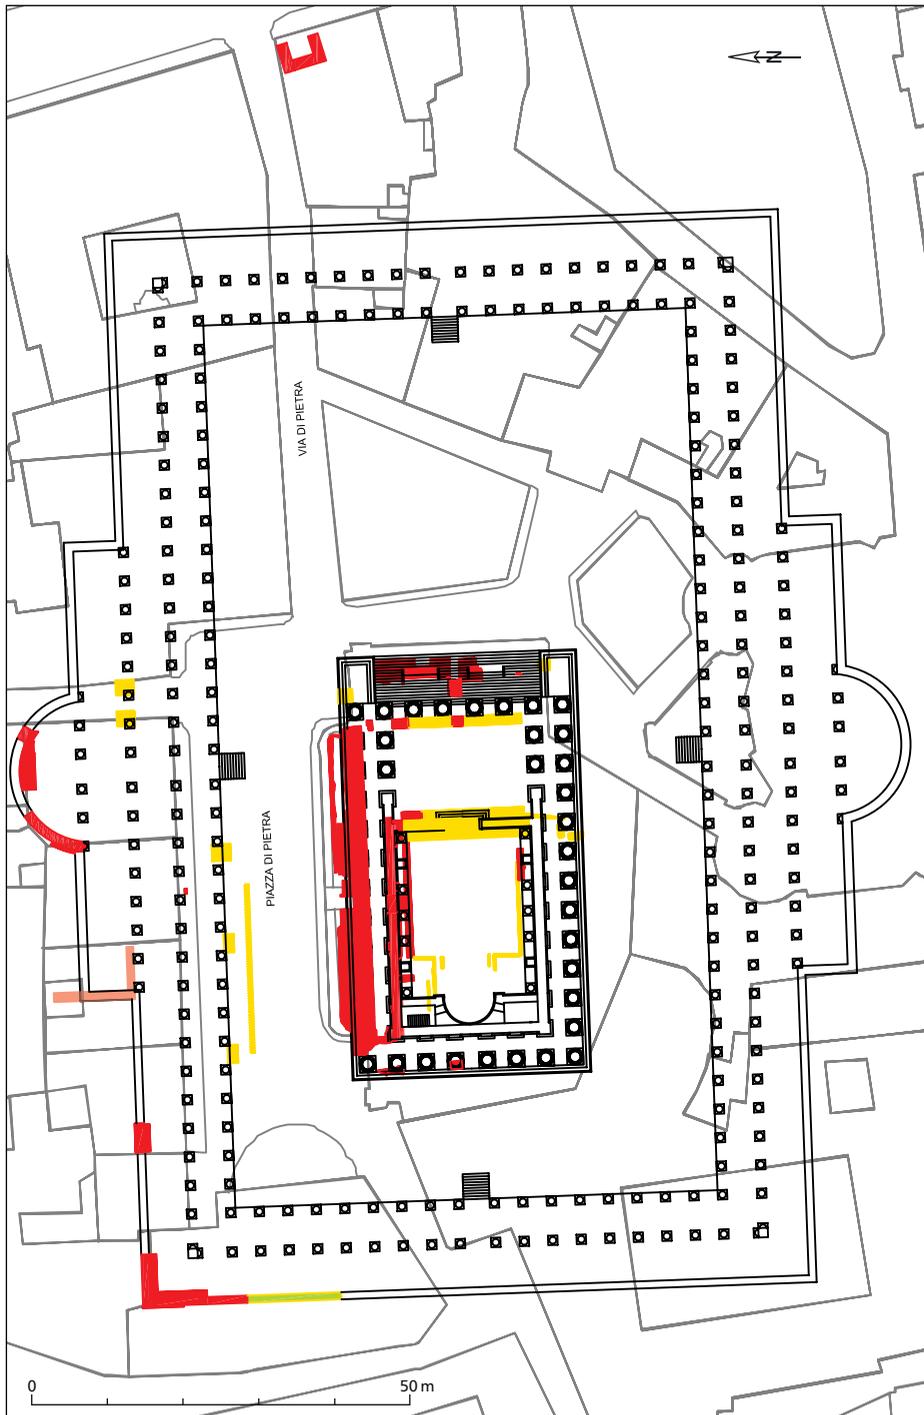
(oben) Grundriss. Maßstab 1:1000.
